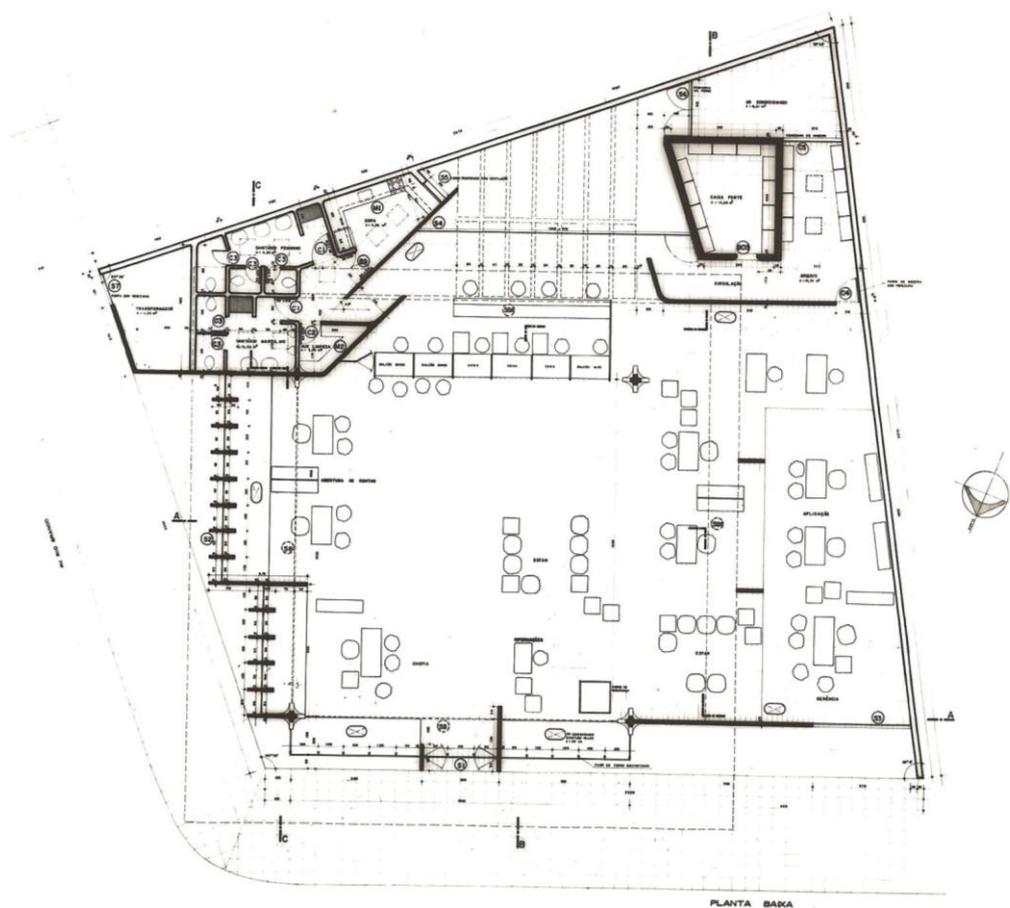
Planta Baixa CEF Torres. Fonte: acervo Debiagi
